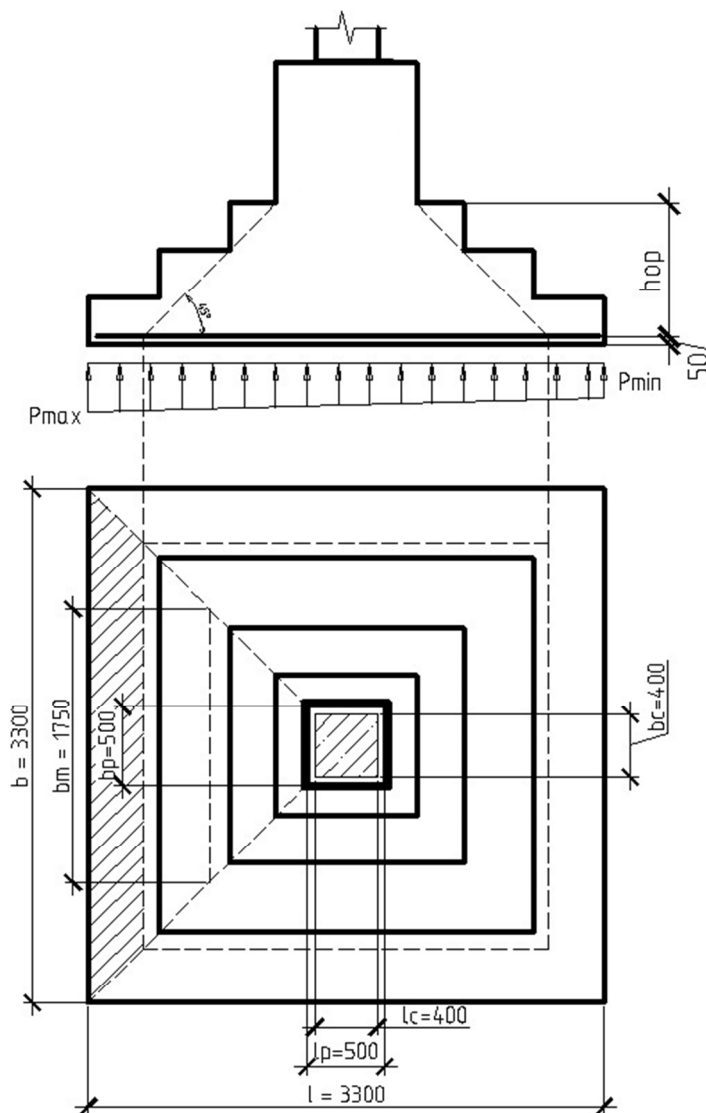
Схема к расчету низкого фундамента на продавливание подколонником
